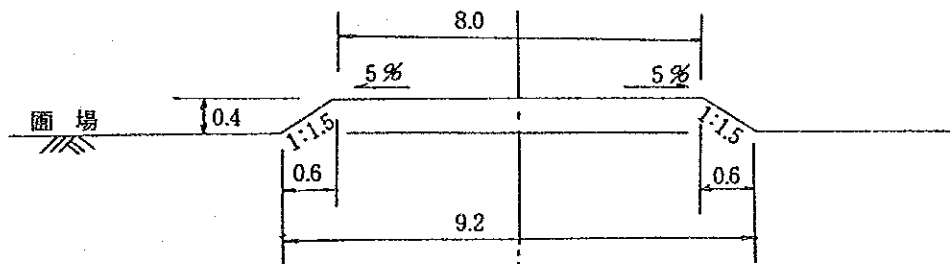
支線道路標準断面図 (タイプ3及び4) (単位: m)
